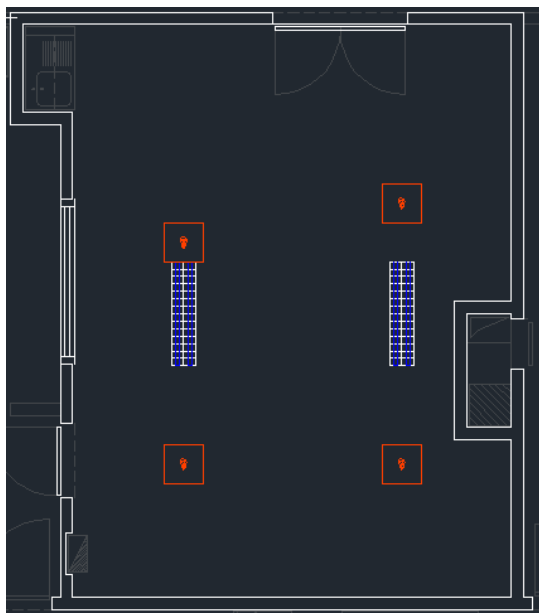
Planta Autocad da Sala de Raio-X nº 11
